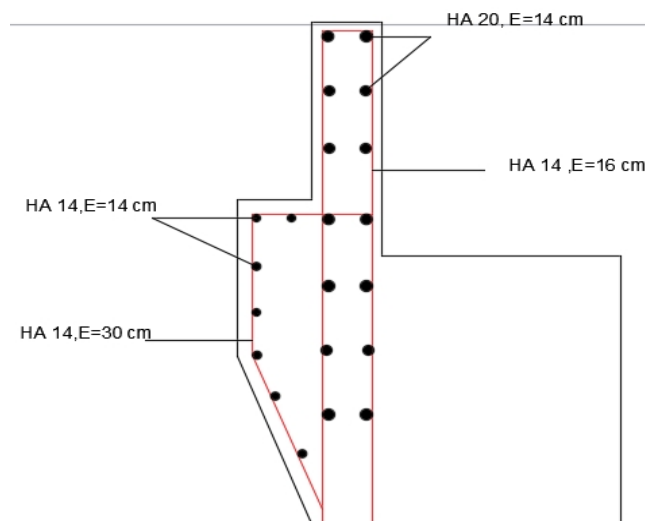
Ferraillage de mur garde grève et du corbeau
